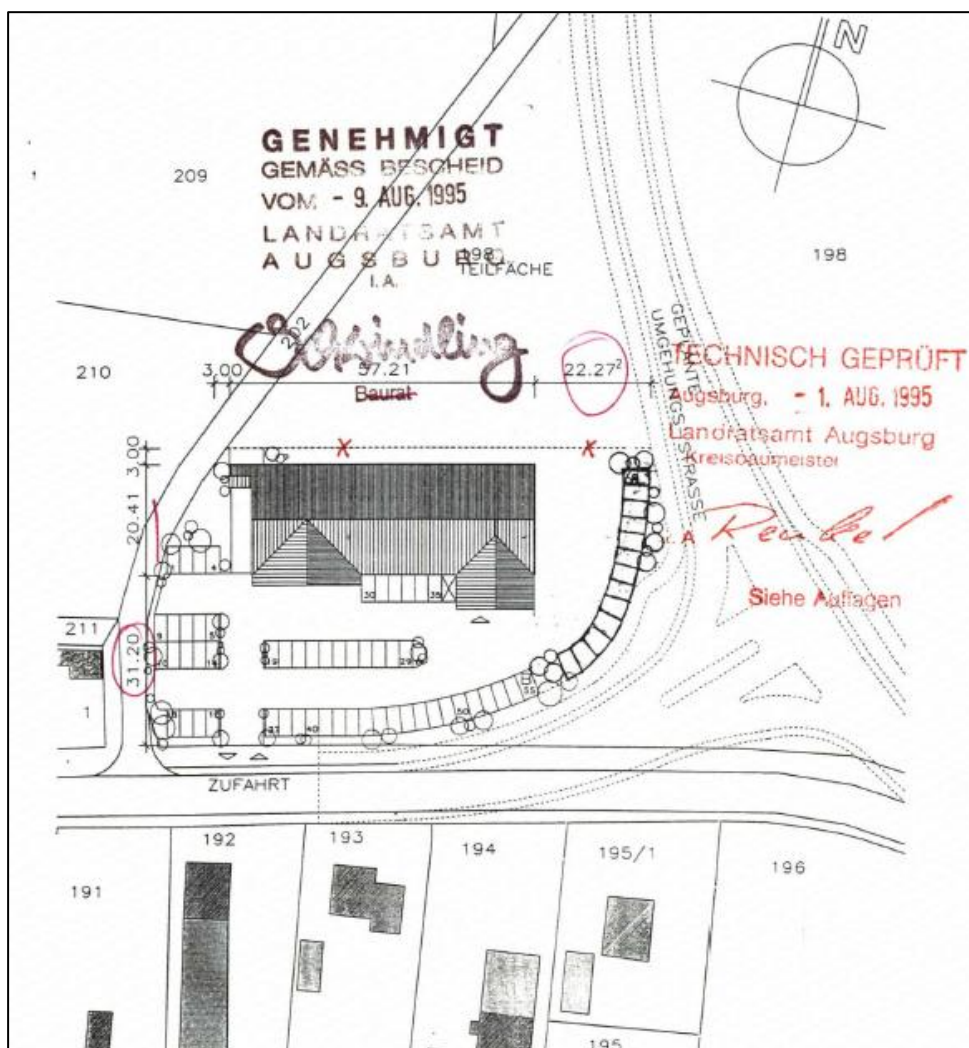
Auszug aus dem Lageplan zum Baugenehmigungsverfahren, gefertigt 08.12.1994
